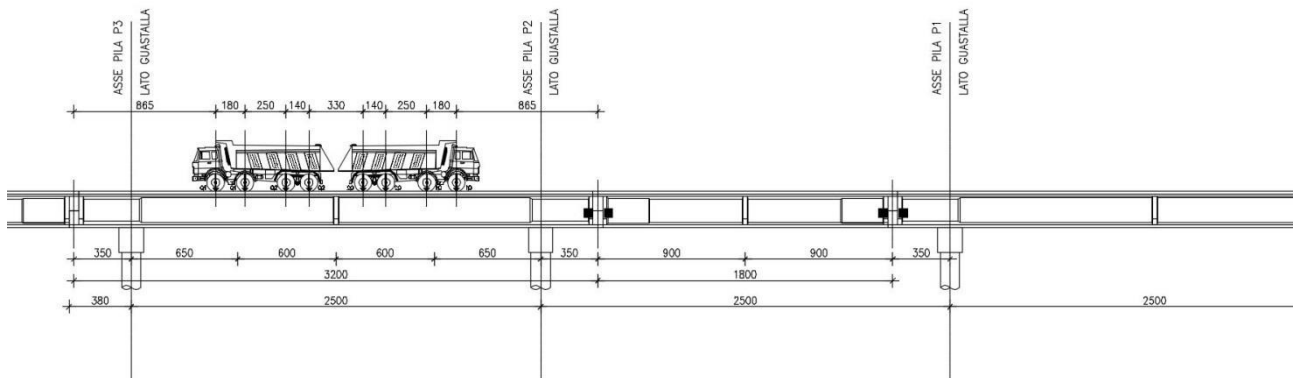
Terza disposizione dei carichi per la prova nel ponte lato Guastalla
